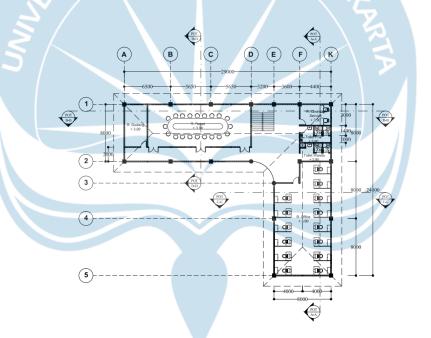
Denah Arsitektur Bangunan Edukasi Lantai 1 dan 2
